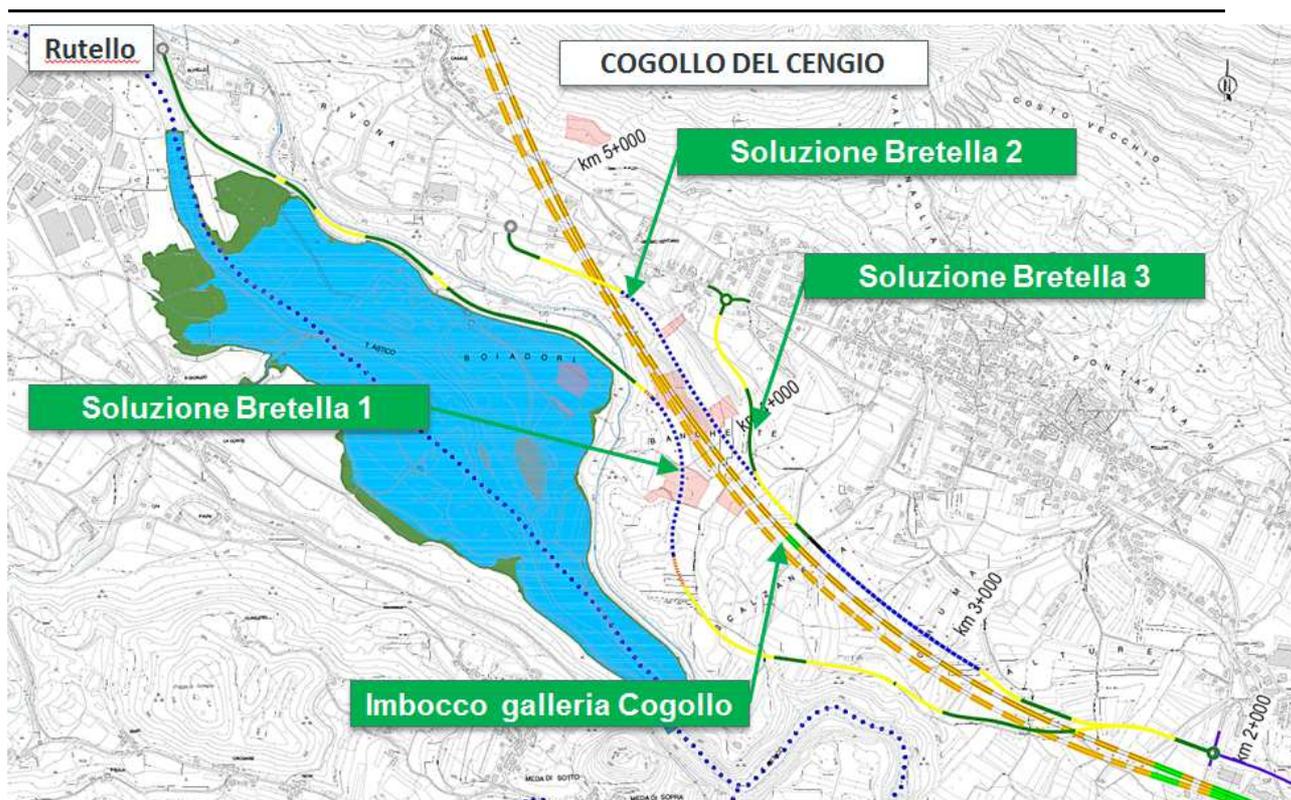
Planimetria di confronto delle 3 alternative per la bretella di bypass di Cogollo del Cengio
